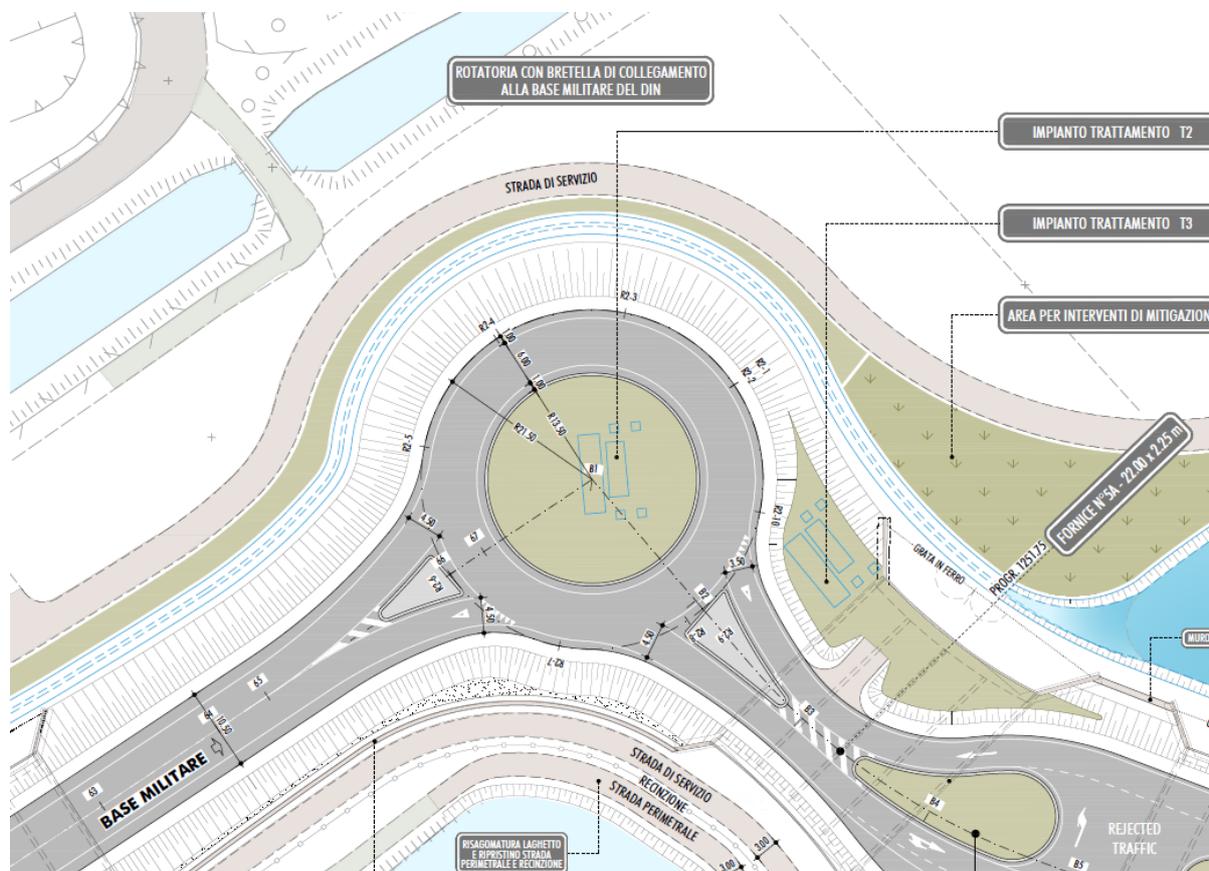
INTERSEZIONE A ROTATORIA DI COLLEGAMENTO ALLA BASE MILITARE “DEL DIN”
